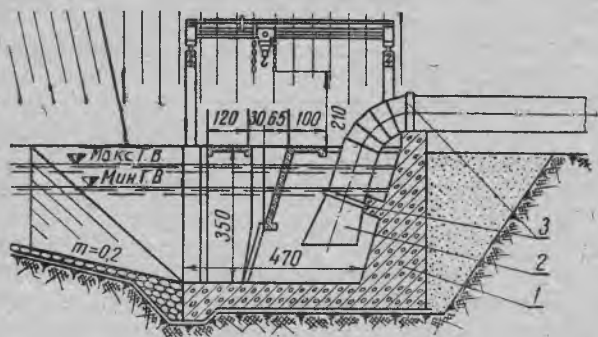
Крепление всасывающей трубы стальными хомутами на стене водоприемного сооружения:
